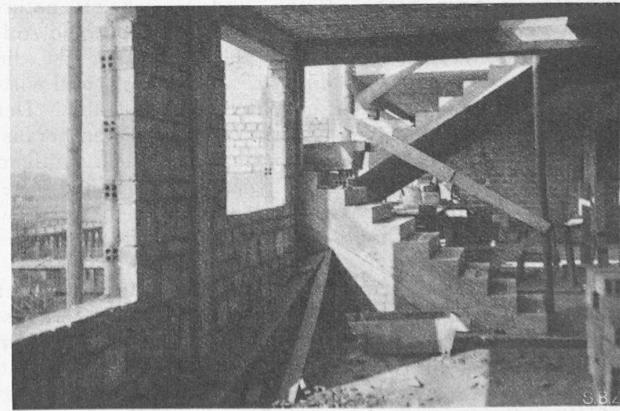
Treppen im Eisenbeton-Skelettbau.
